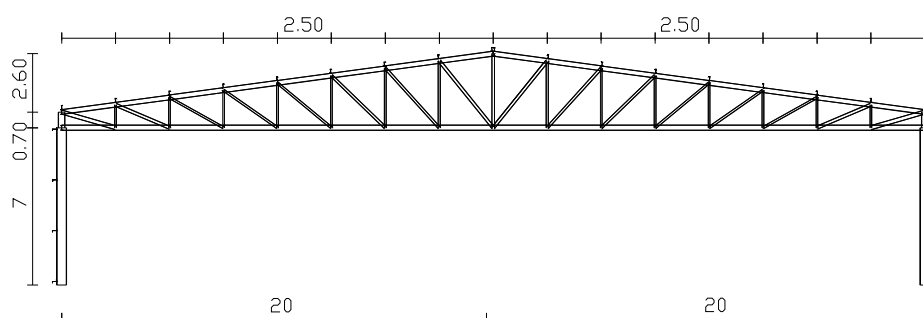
Pórtico com pilar de alma cheia, viga em treliça, vão de 40.00m
